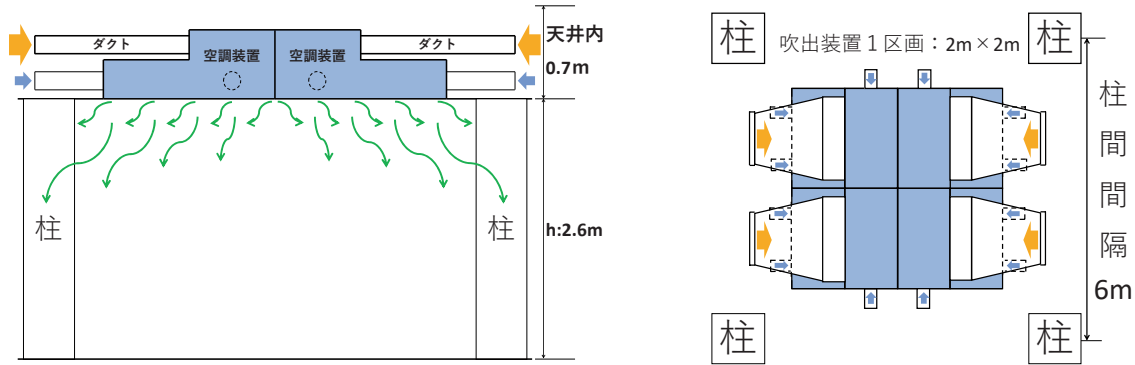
空調装置の構造 (左: 断面図, 右: 平面図)
